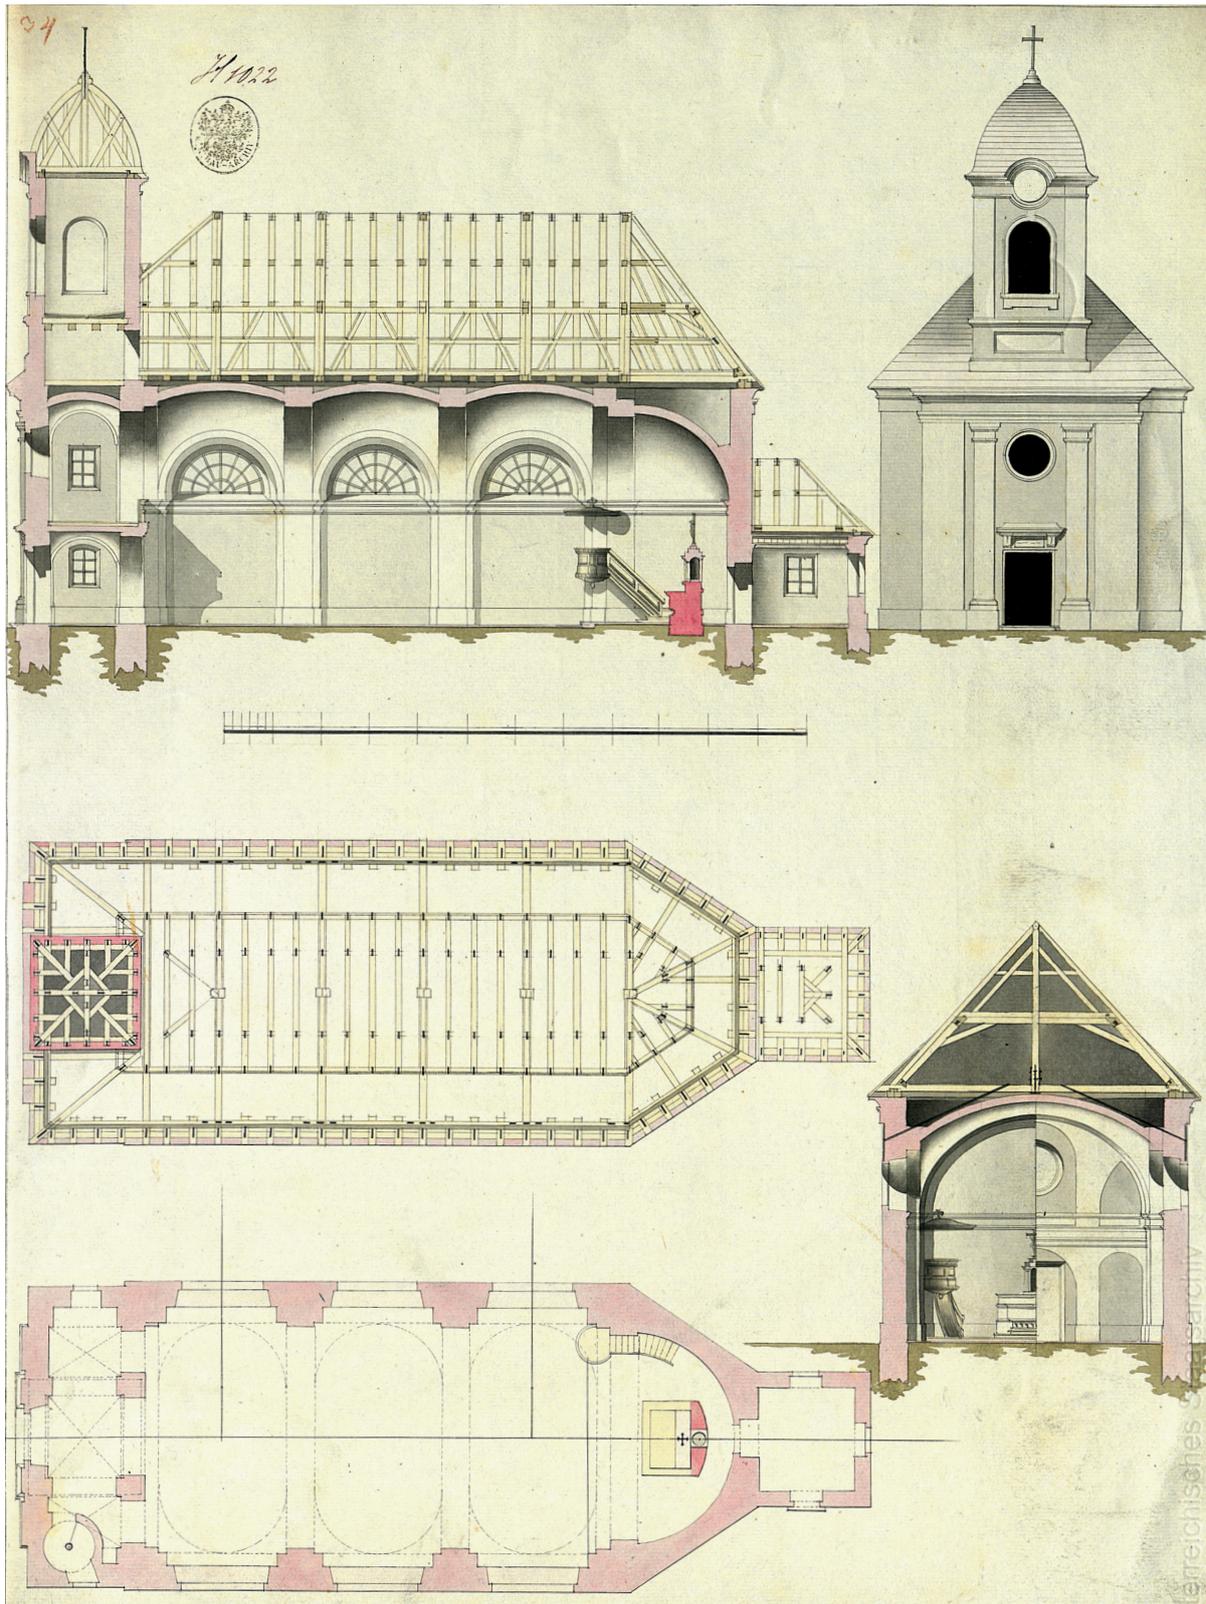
Josephinische Musterkirche, Längsschnitt, Fassadenaufriss, Dachstuhl, Querschnitt und Grundriss, um 1783 (Wien, AVA, Plansammlung I, Mappen 632–635, Inv.-Nr. I c)
